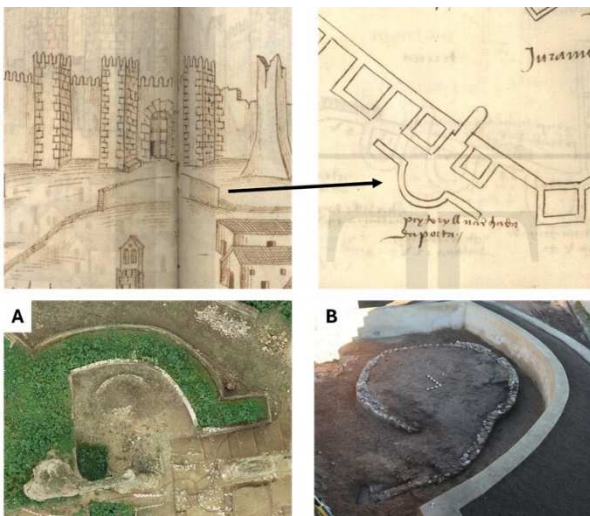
Em cima: pormenores da vista da Porta Norte (esquerda) e da planta do Castelo de Juromenha (à direita), com a barbacã assinalada, de Duarte d'Armas. Em baixo: Cavaleiro a Barbete, antes da intervenção (A) e após a escavação (B).
